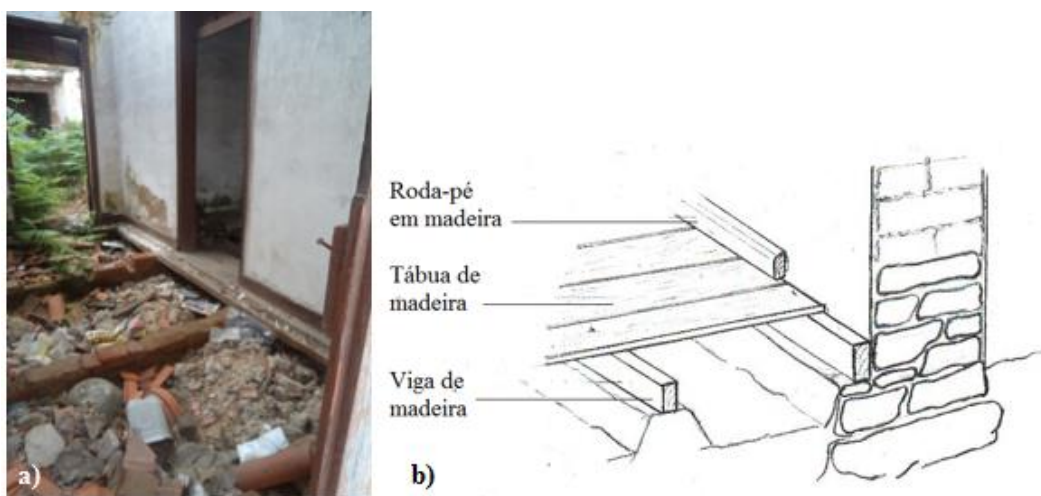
a) Estrutura de pavimento em madeira, b) Pormenor construtivo do pavimento em construções de adobe (Fonte: Arqº Jorge Mascarenhas e de autor)
